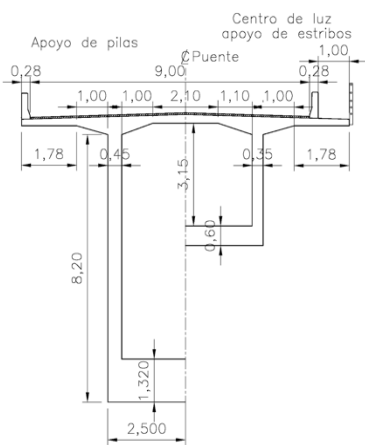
Sección transversal de las dovelas cero (mitad izquierda) y de cierre (mitad derecha). Fuente: Autores.
